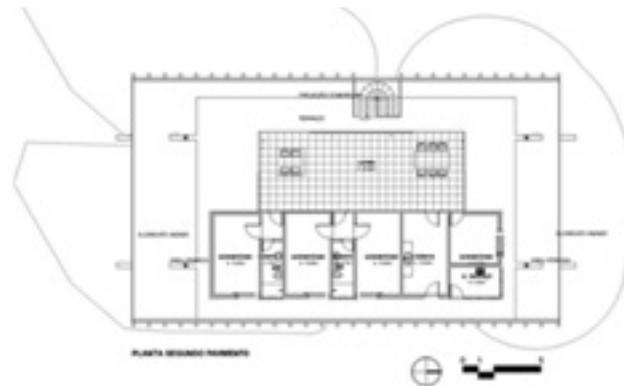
Planta baixa do pavimento superior da Residência Guido Weber, Caiobá. (1965).
